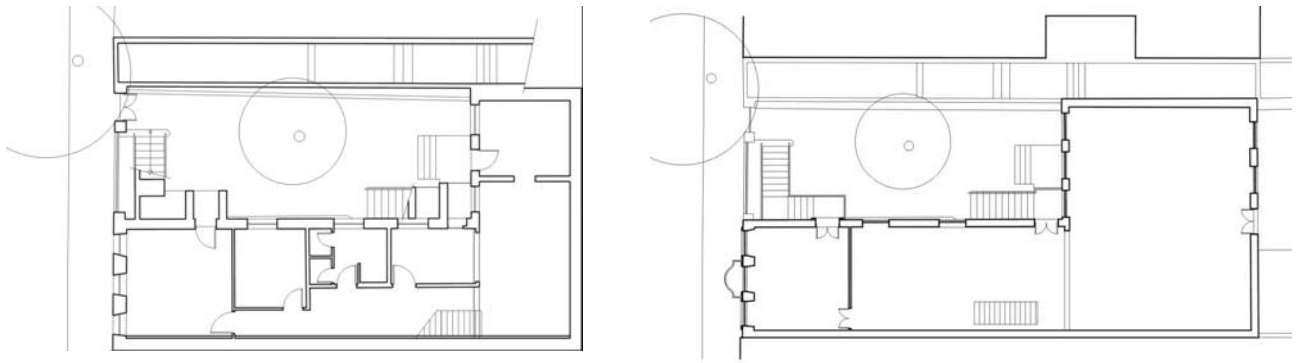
Planta Baixa Pav. Térreo (e) e Planta Baixa Pav. Superior (d) do existente, 2004
